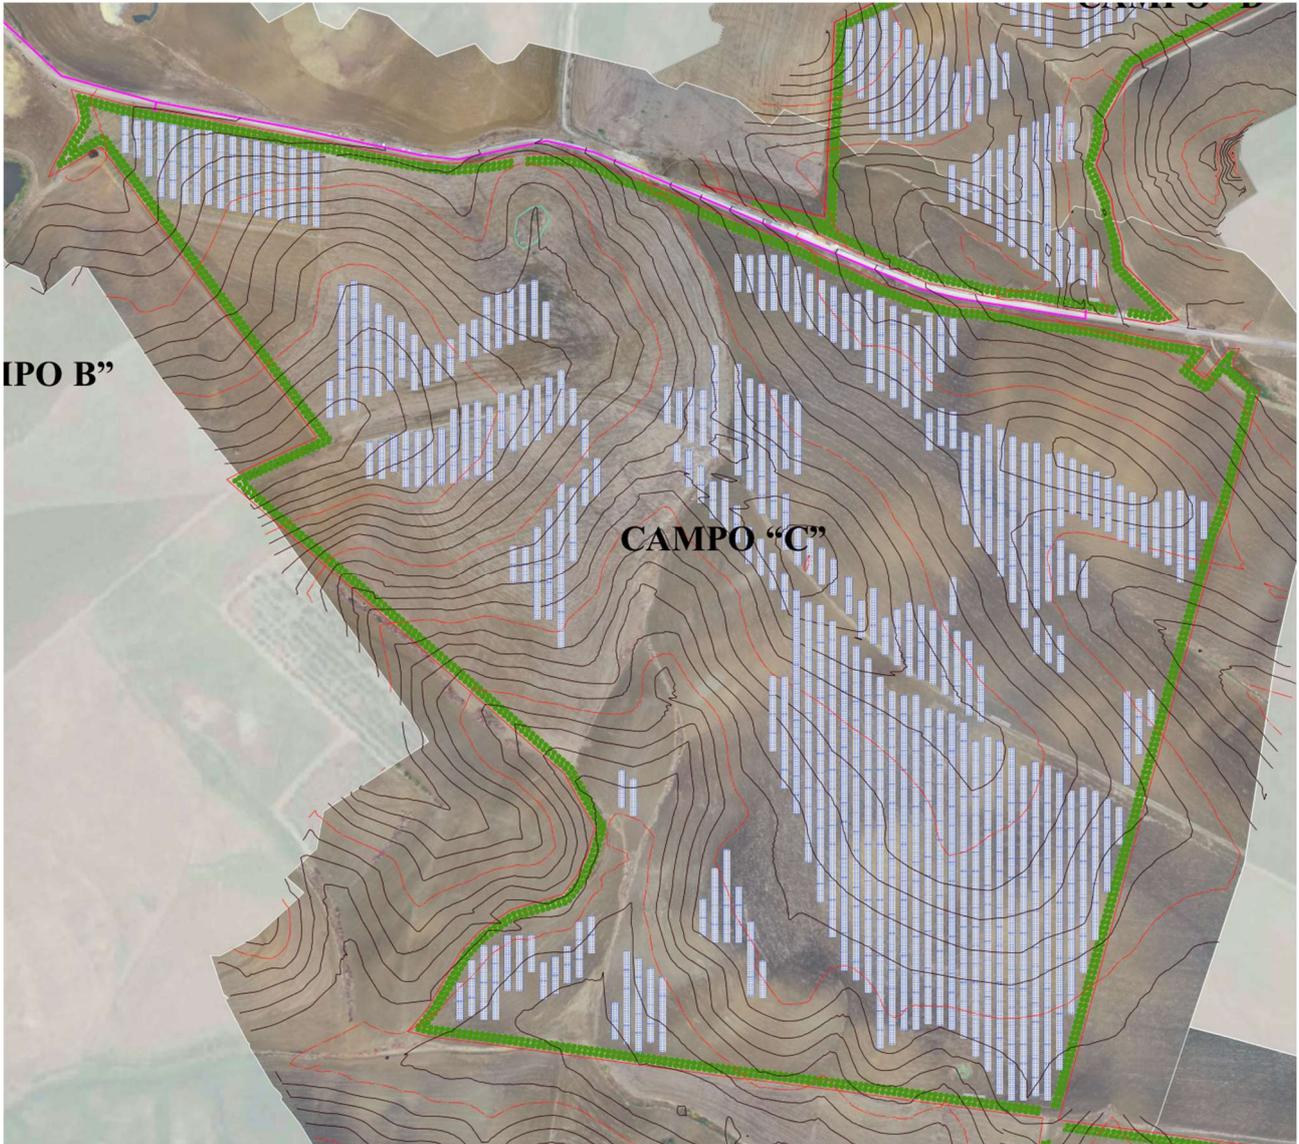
Particolare Layout di impianto area C su stralcio rilievo
